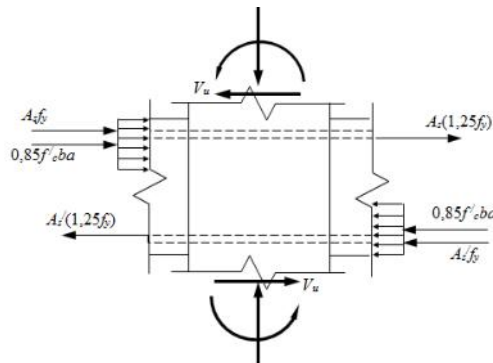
Syarat Tulangan Transversal pada Kolom.
